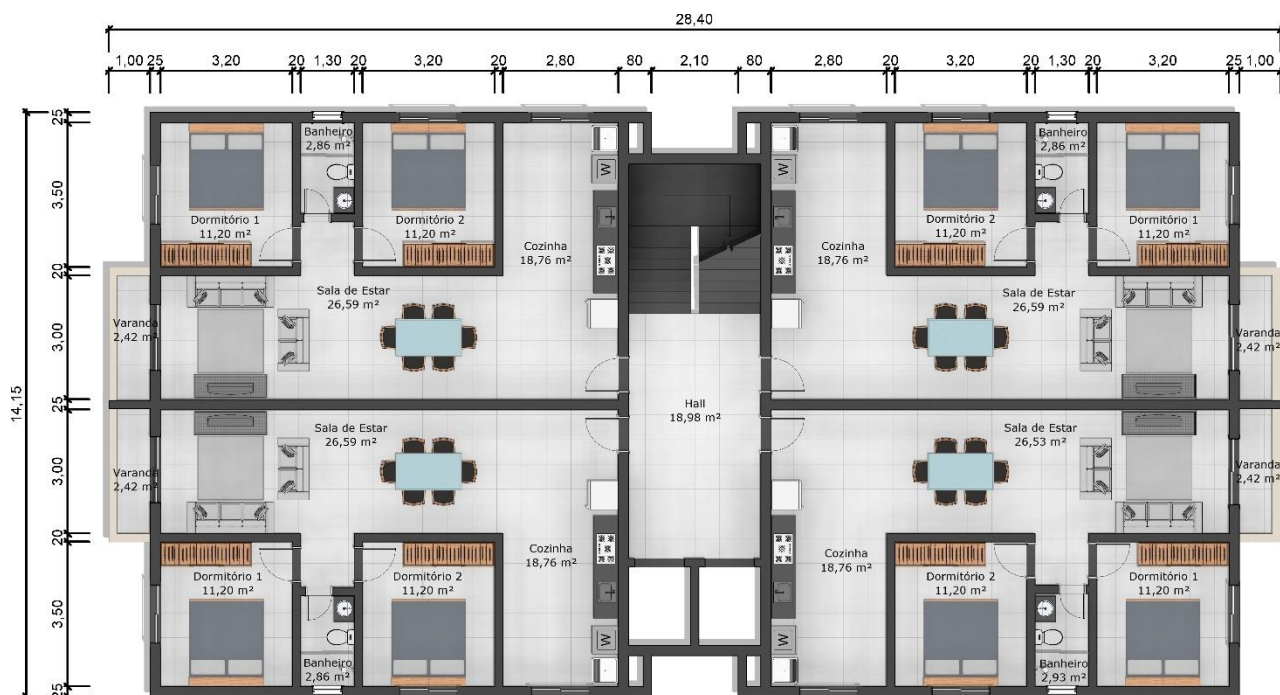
Planta baixa do pavimento tipo. (Fonte: Autor; 2022)
